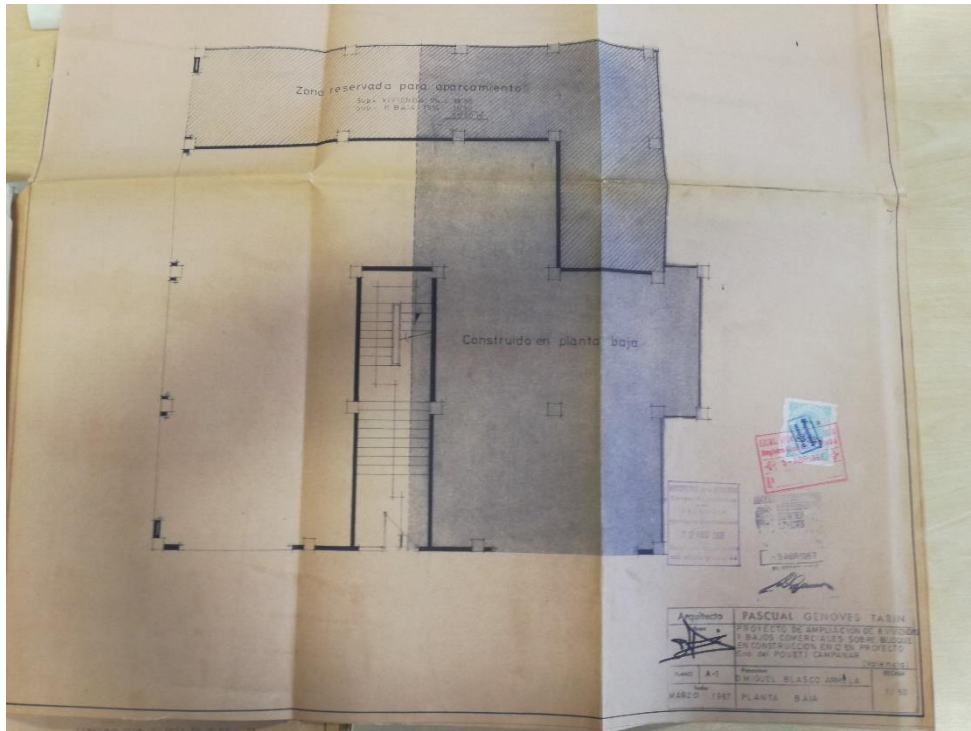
Planta baja Riola 1. Archivo Histórico Municipal
